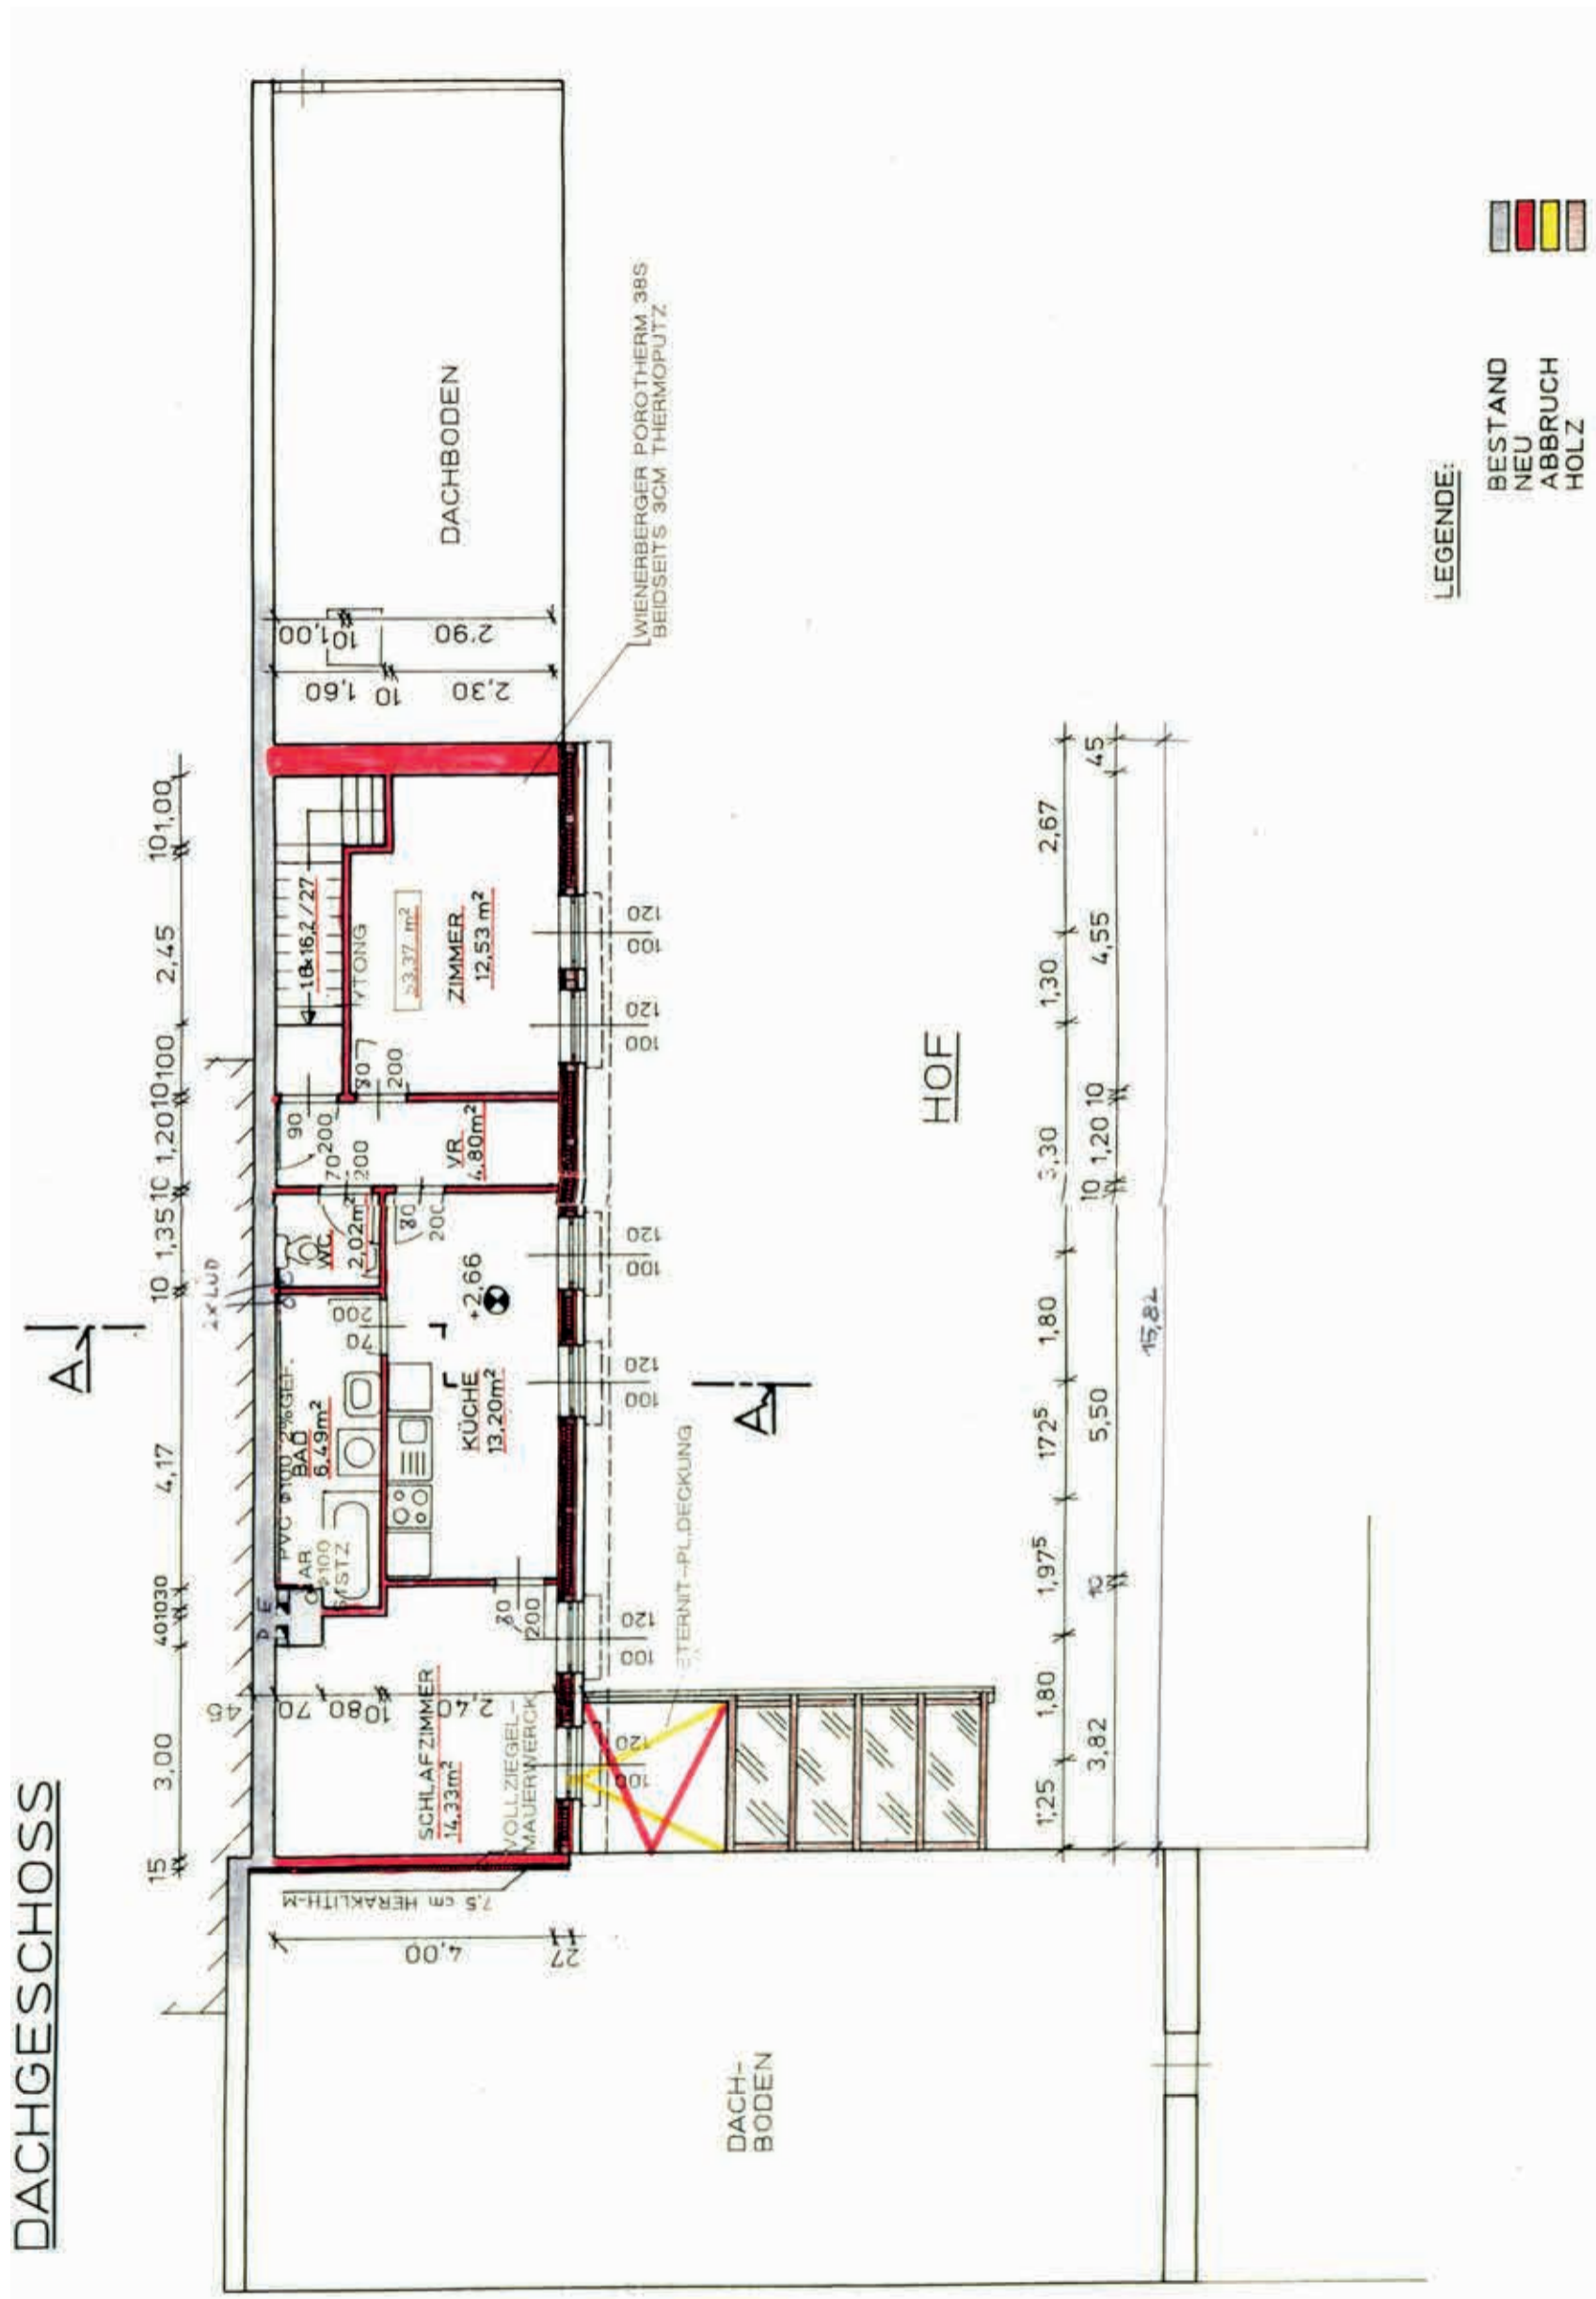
Einreichplan | Dachgeschoß | M 1:100 | 1993
